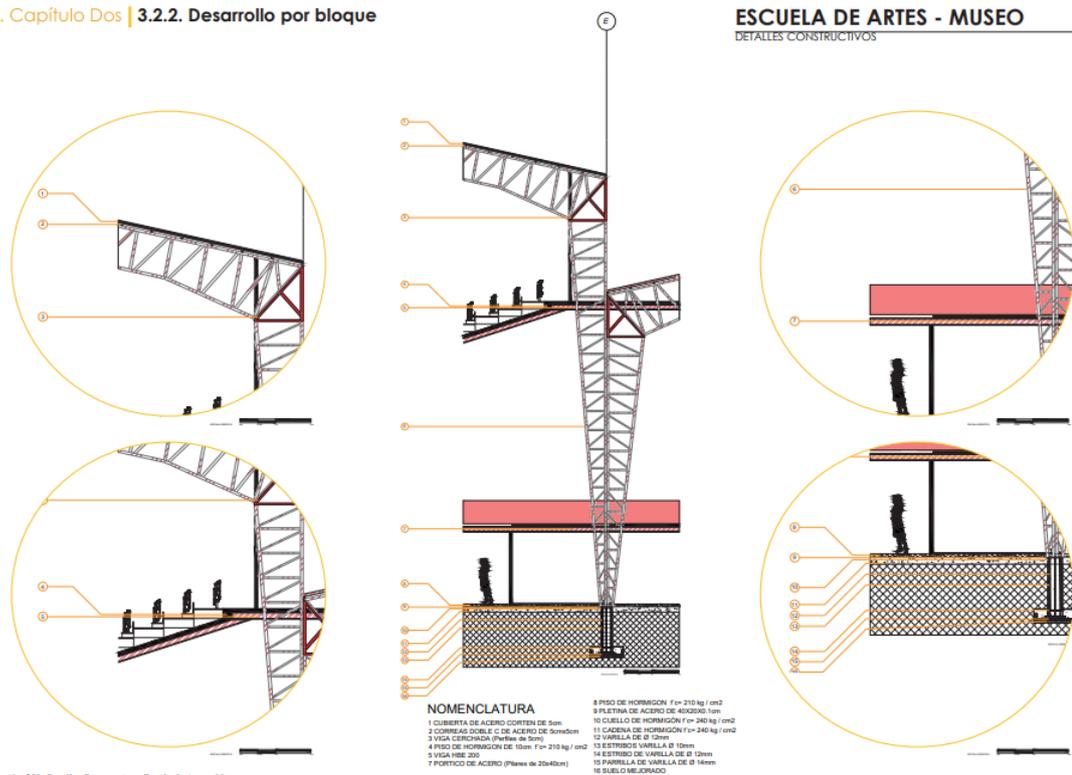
Detalles Constructivos Escuela de Artes - Museo
